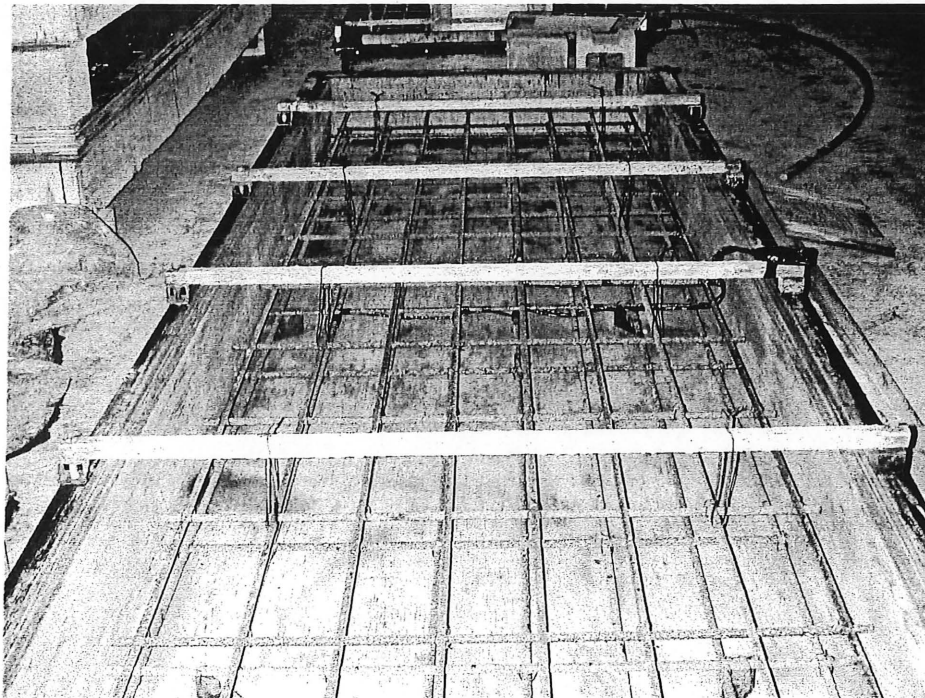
Coffrage de la dalle renforcée en PRFV
